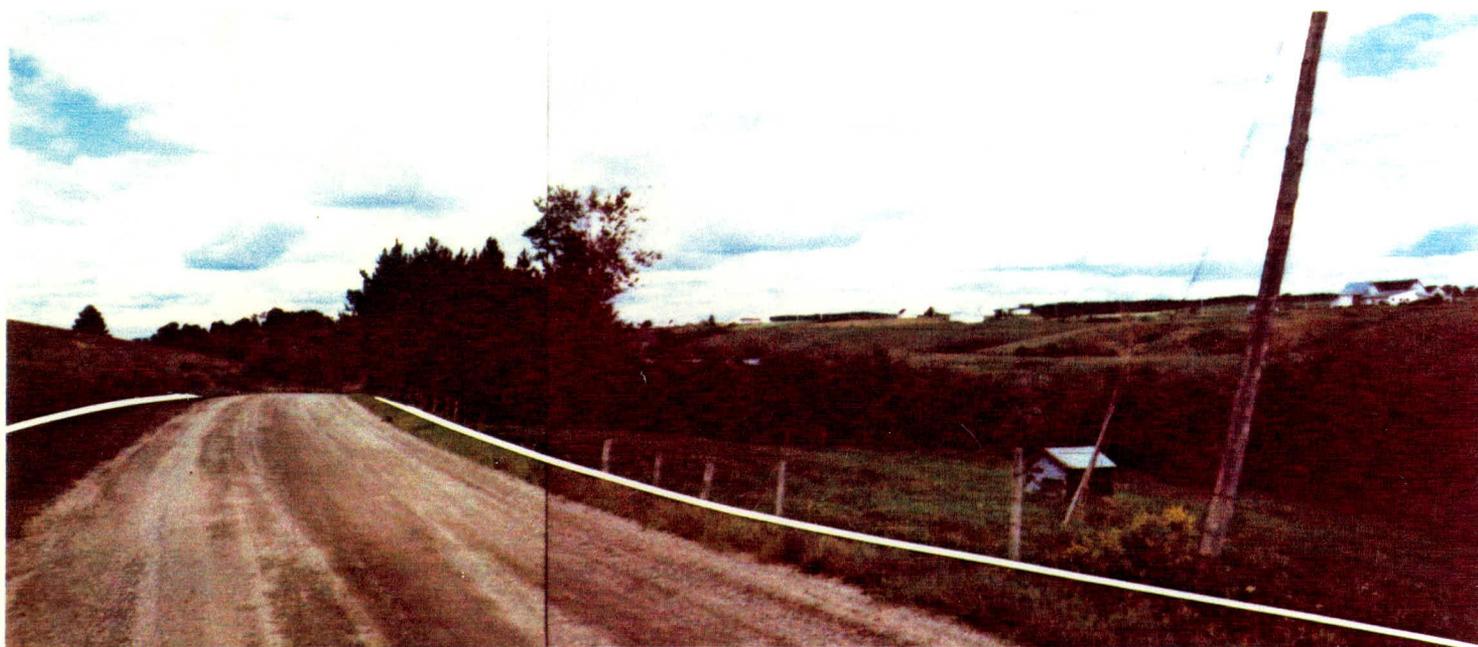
PHOTO PRISE AU CHAINAGE 2+750 VERS LE NORD MONTRANT UNE PARTIE DE L'AULNAIE SITUÉE A DROITE DE LA ROUTE SUR LA PHOTO.
